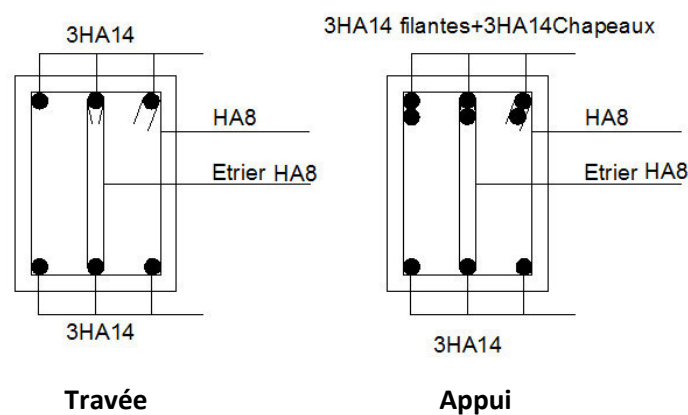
Schéma du ferrailage de la poutre palière.
